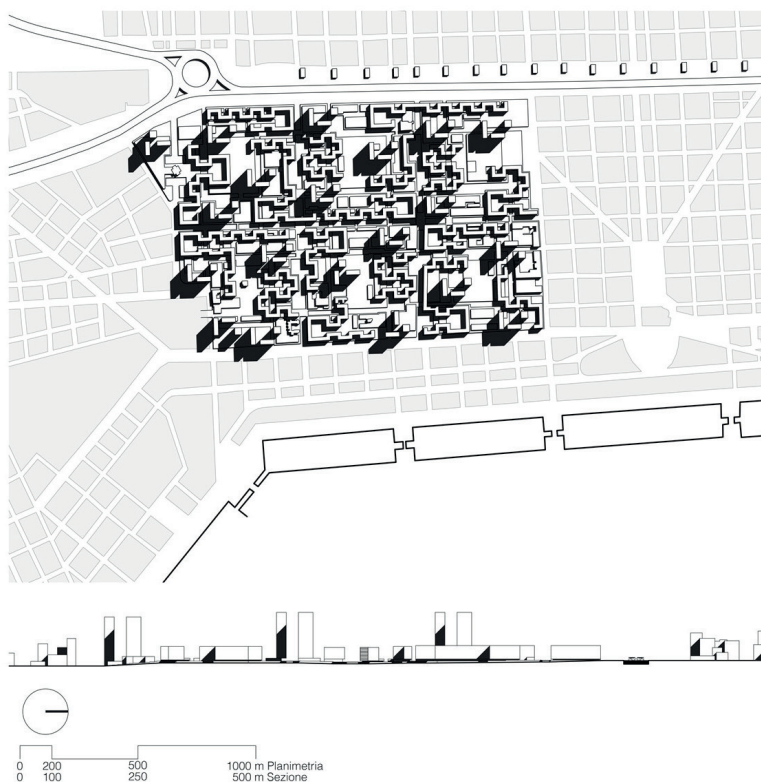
Plan de Urbanización Barrio Sur. Fuente: elaboración dell'autore.
